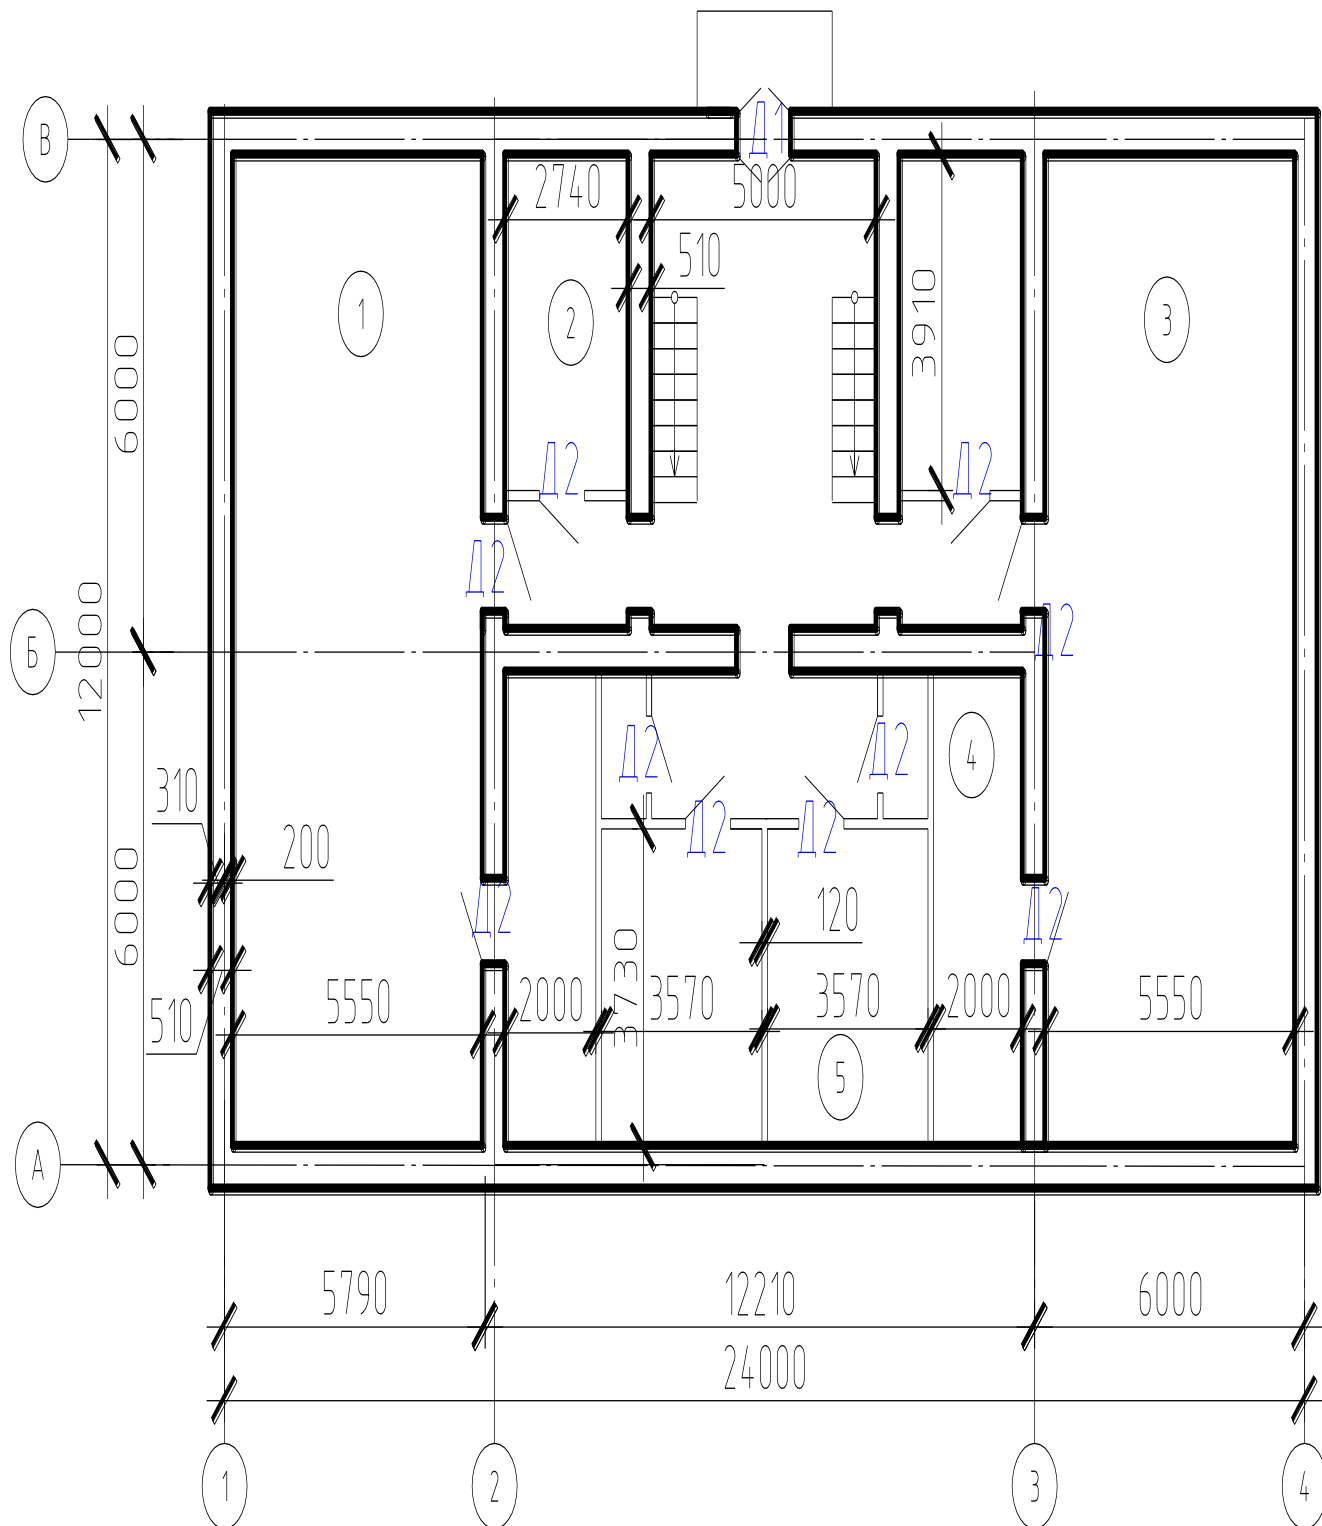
Детское дошкольное учреждение. План 1-го этажа
